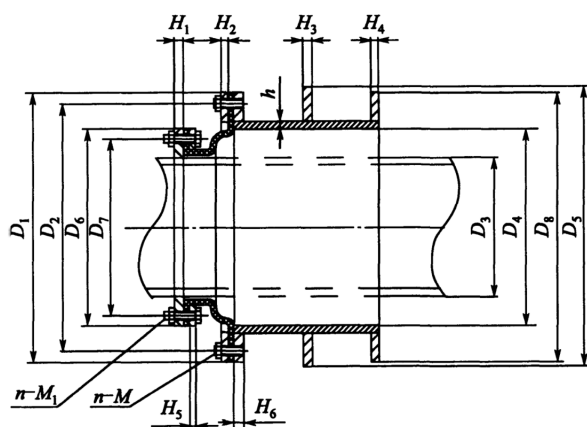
II 型焊接连接橡胶柔性防水套管尺寸图
